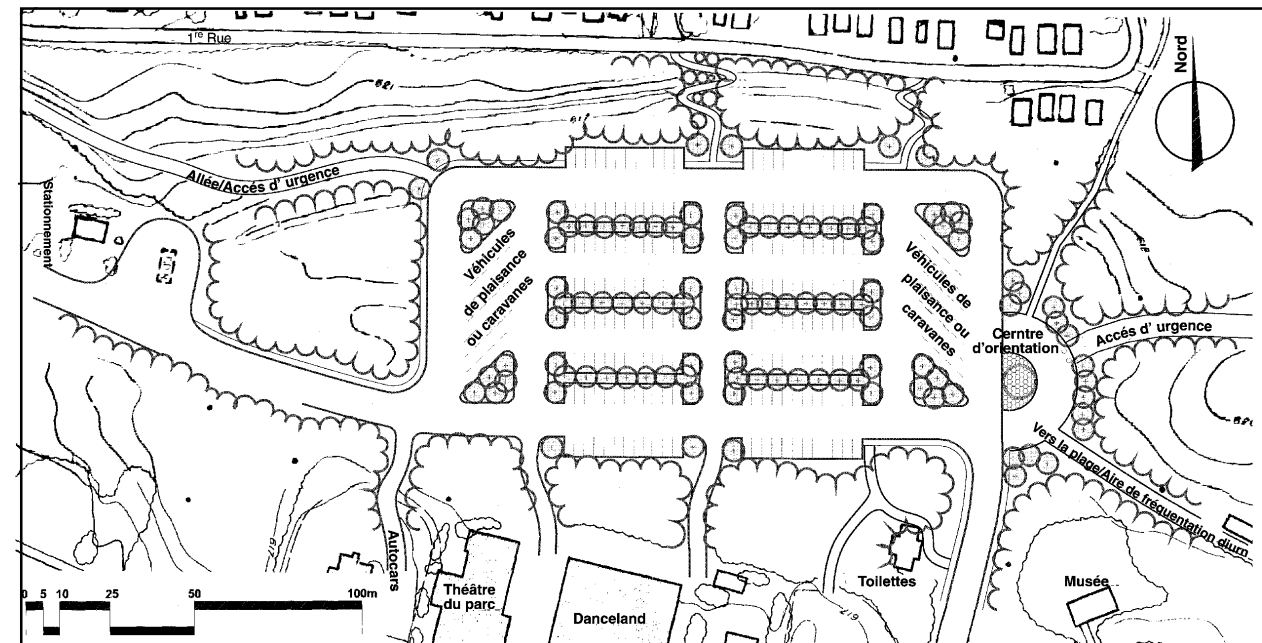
Plan du réaménagement du grand terrain de stationnement
